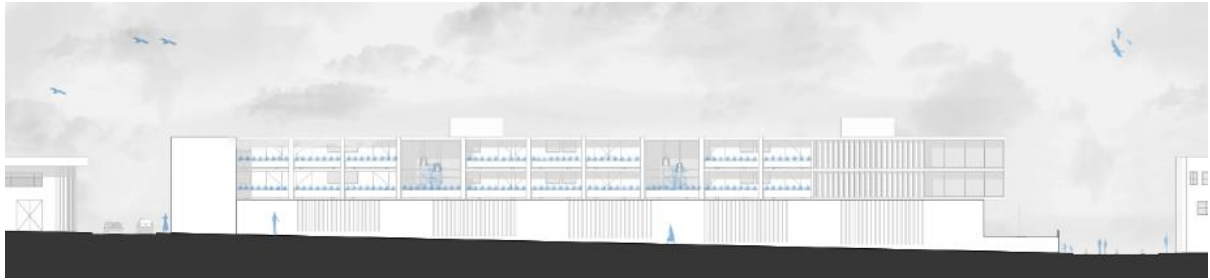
Fachada calle Gonzalo Pizarro. Elaboración propia.
